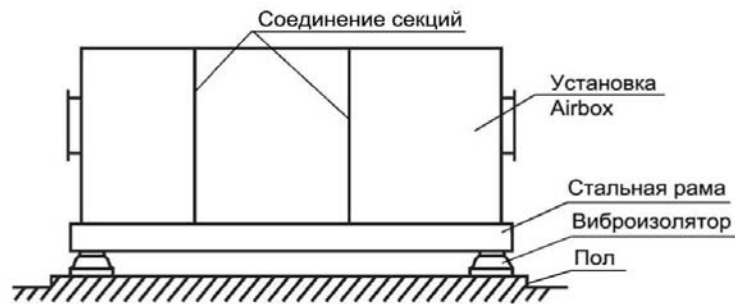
Размещение установки на стальной раме с виброизоляторами
